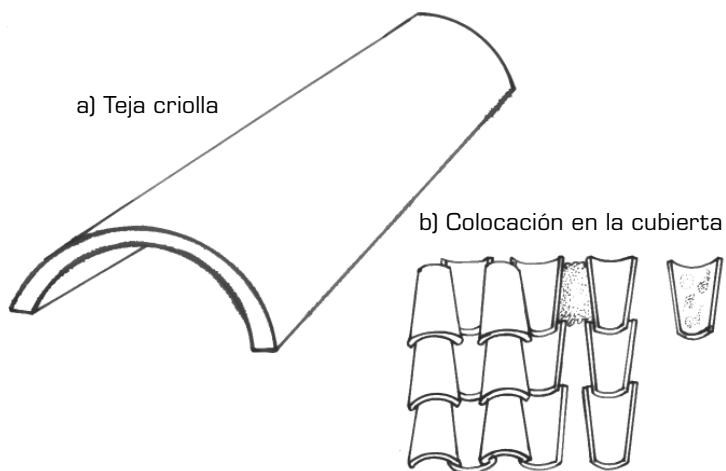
Tejas criollas para colocación en la cubierta.
